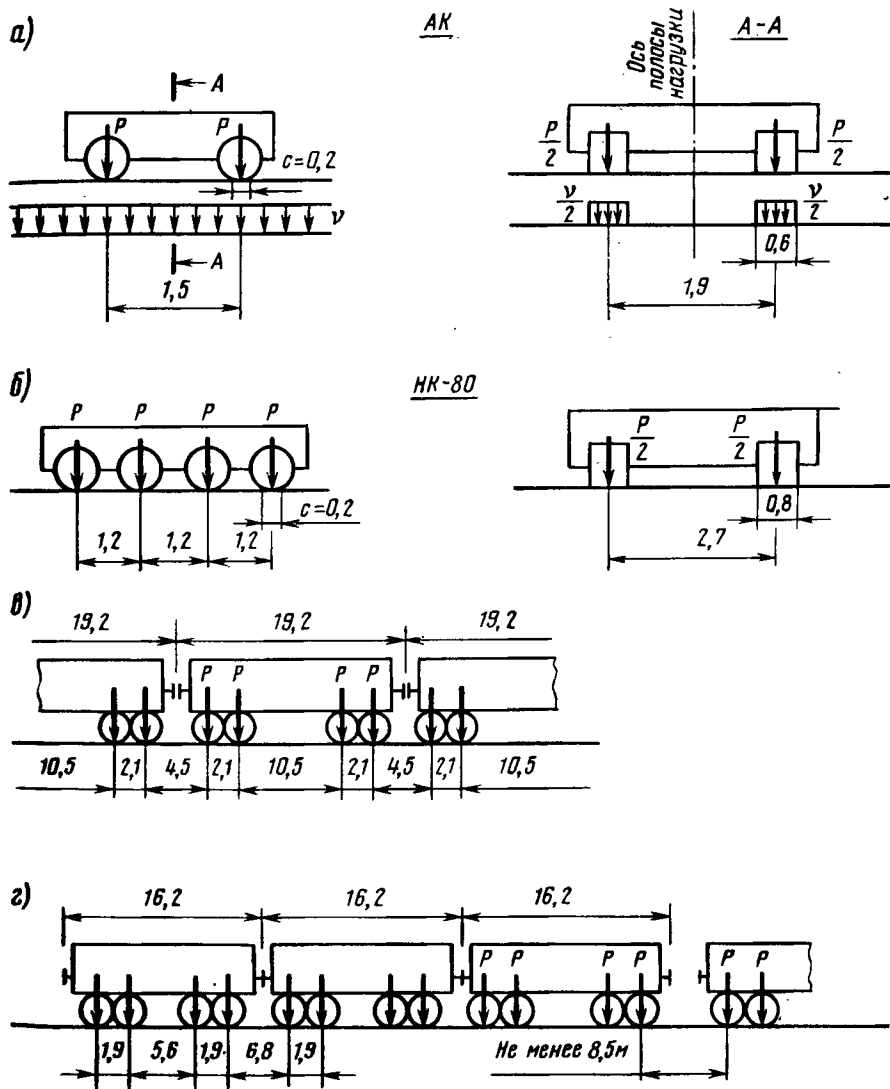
Схемы нагрузок от подвижного состава для расчета городских мостов, путепроводов и эстакад:
